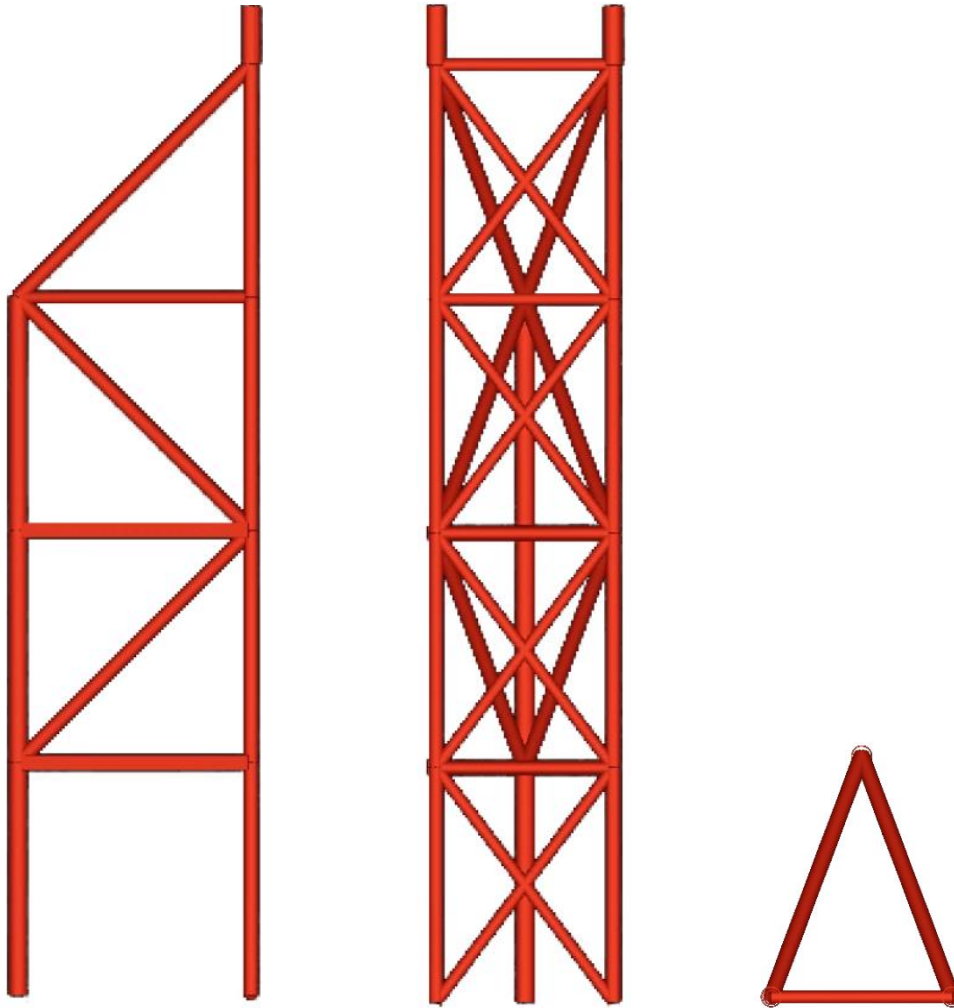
VISTAS DE LA CELOSÍA DEL SOPORTE. DE IZQUIERDA A DERECHA: PERFIL, ALZADO EXTERIOR Y PLANTA
